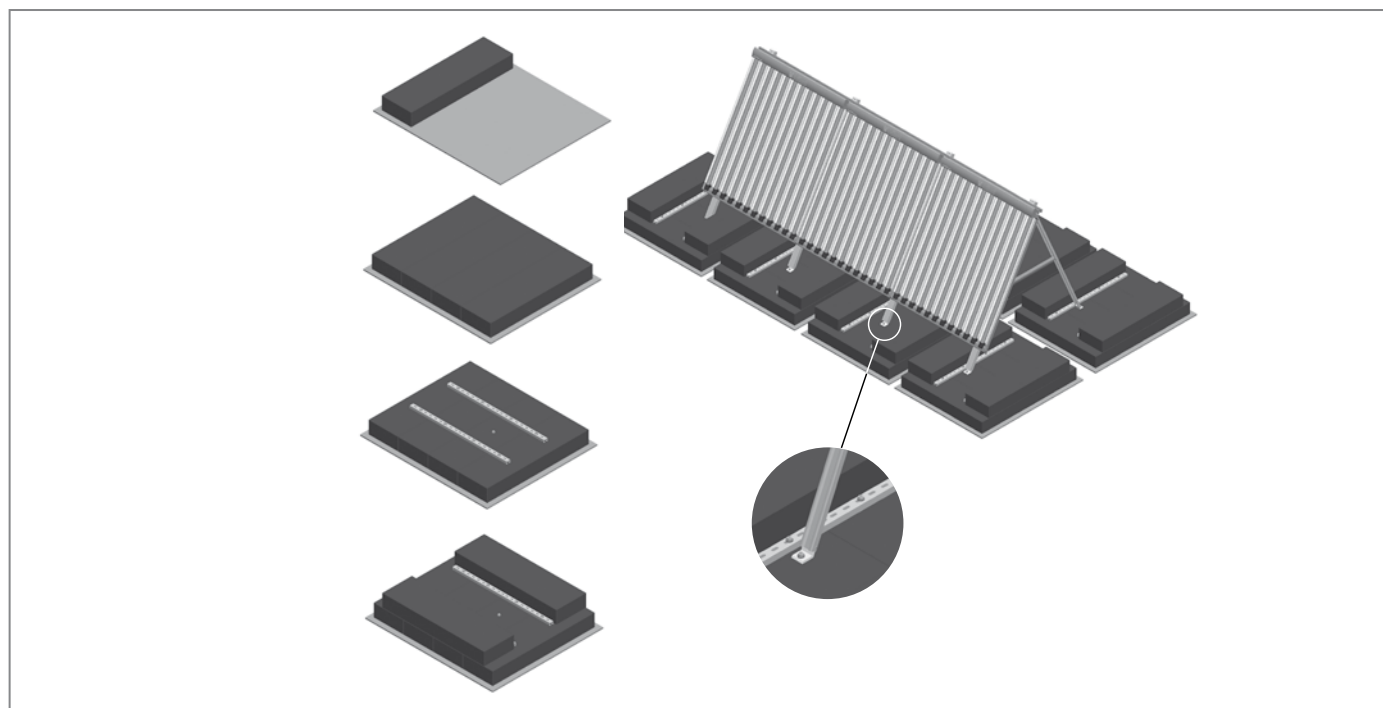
Montage auf Beton- Blockstufensteinen, Verschraubung mit Bolzenanker
